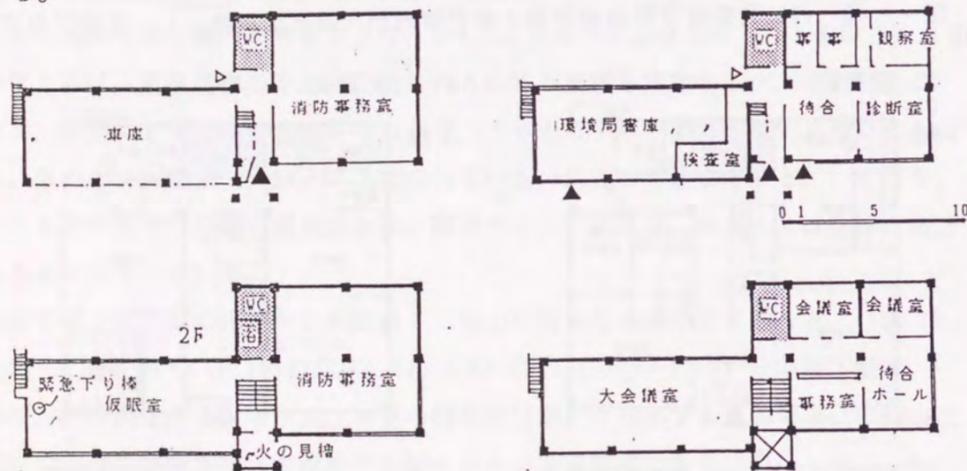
<86>大阪市南市民教養ルーム+休日診療所+倉庫（旧消防署）平面図
